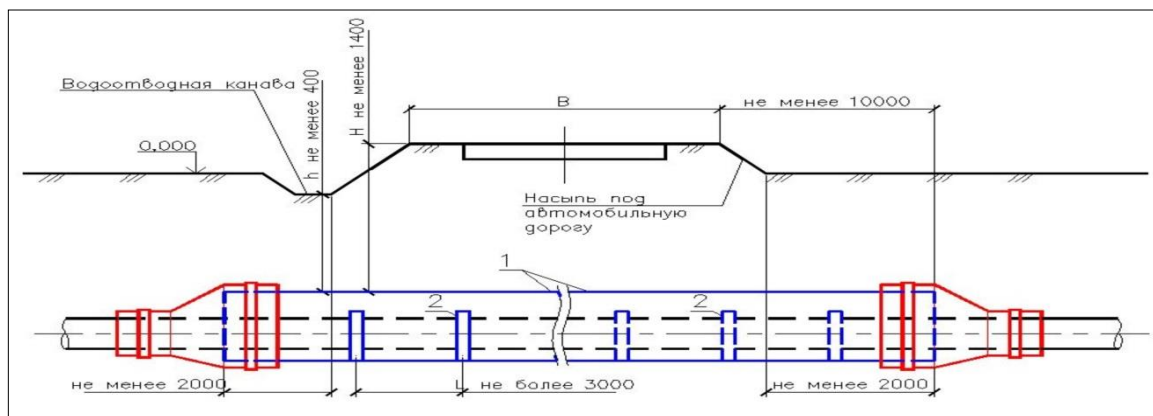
Схема укладки трубопровода на переходе через автодорогу
